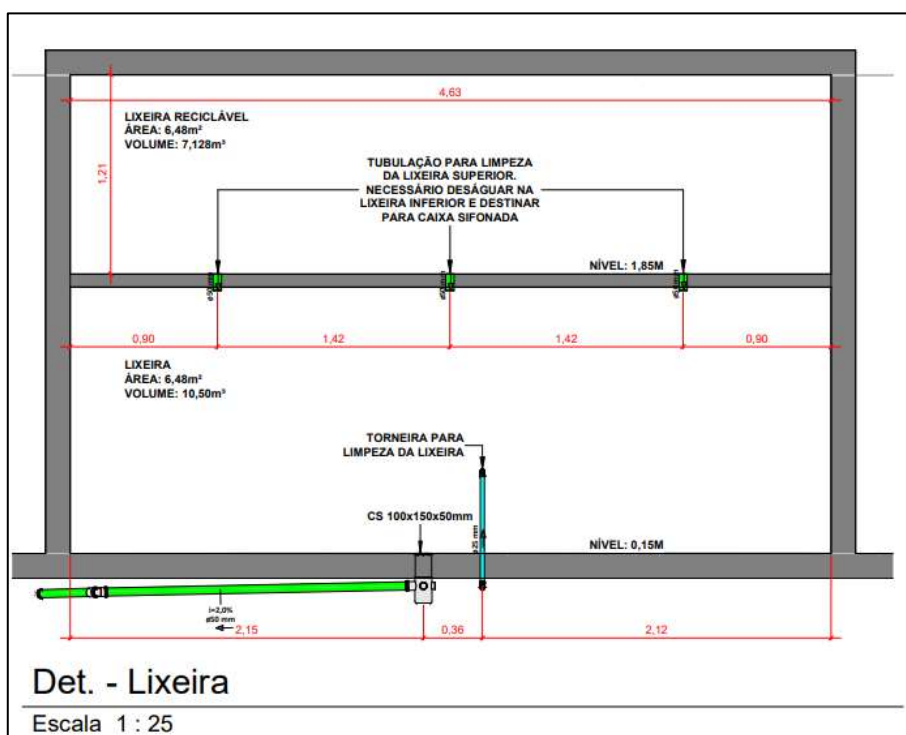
Detalhamento da lixeira do empreendimento. Fonte: Projeto Hidrossanitário – Anexo 5.
